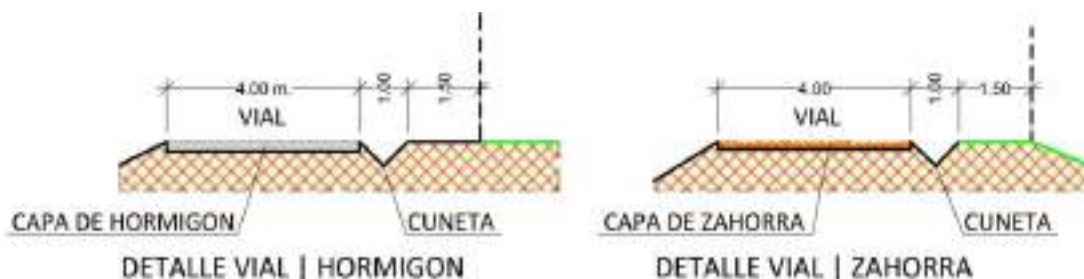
Secciones tipo de camino de servicio con zahorra y pavimento de hormigón
